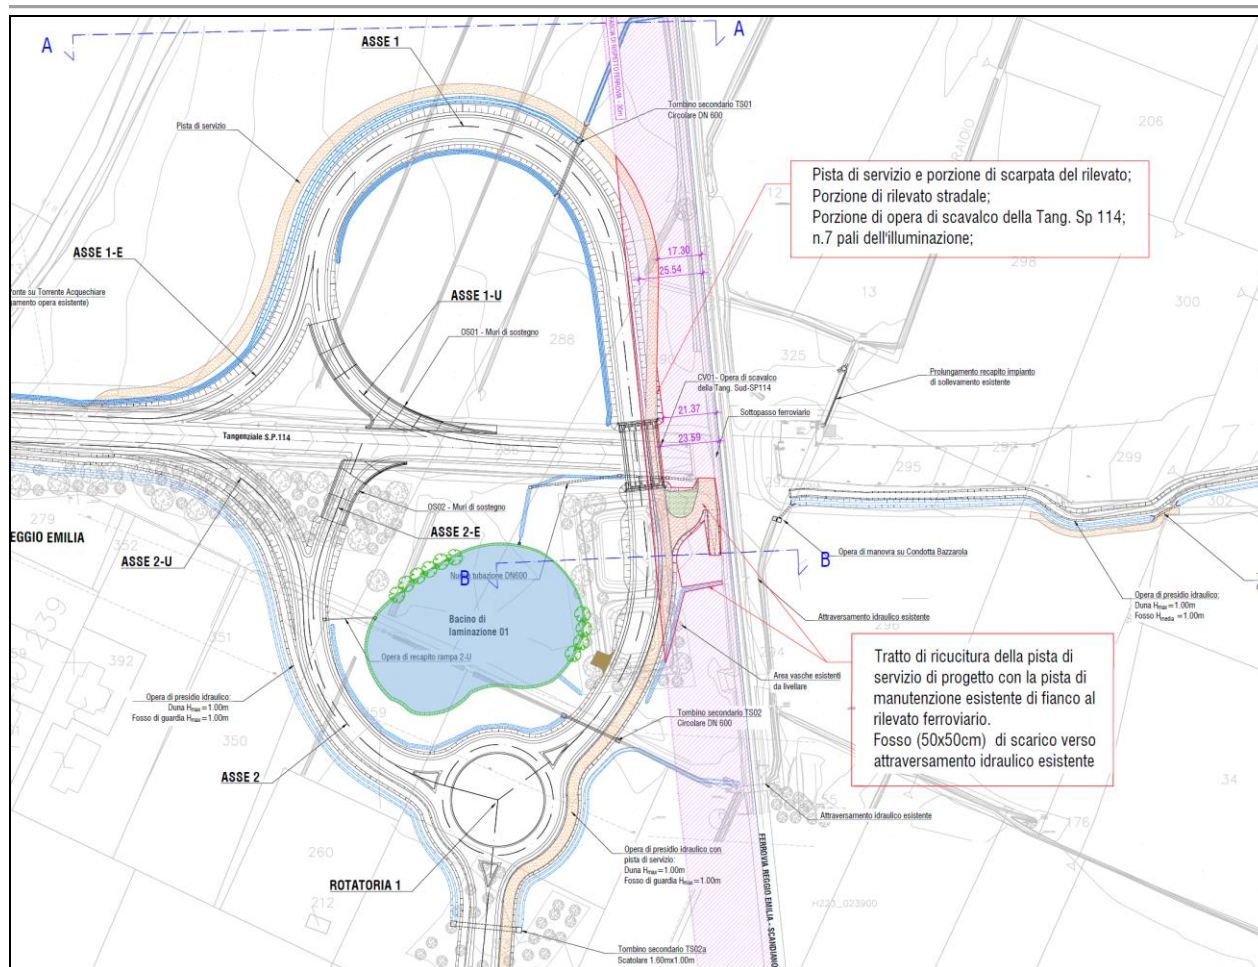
Fascia di rispetto F.E.R. 30m
